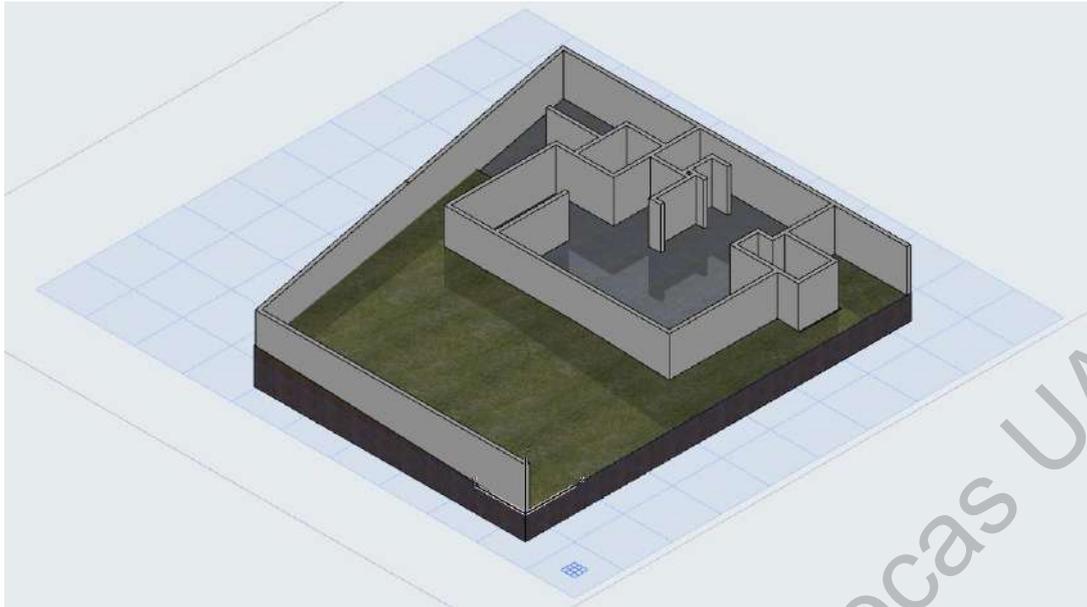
Suelos/Rampas de Planta baja del proyecto 001.
